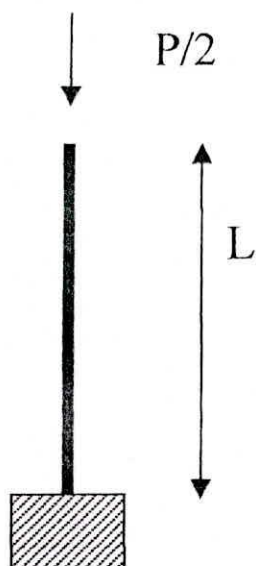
DIAGRAMA DE COLUMNA EMPOTRADA EN SU EXTREMO.
